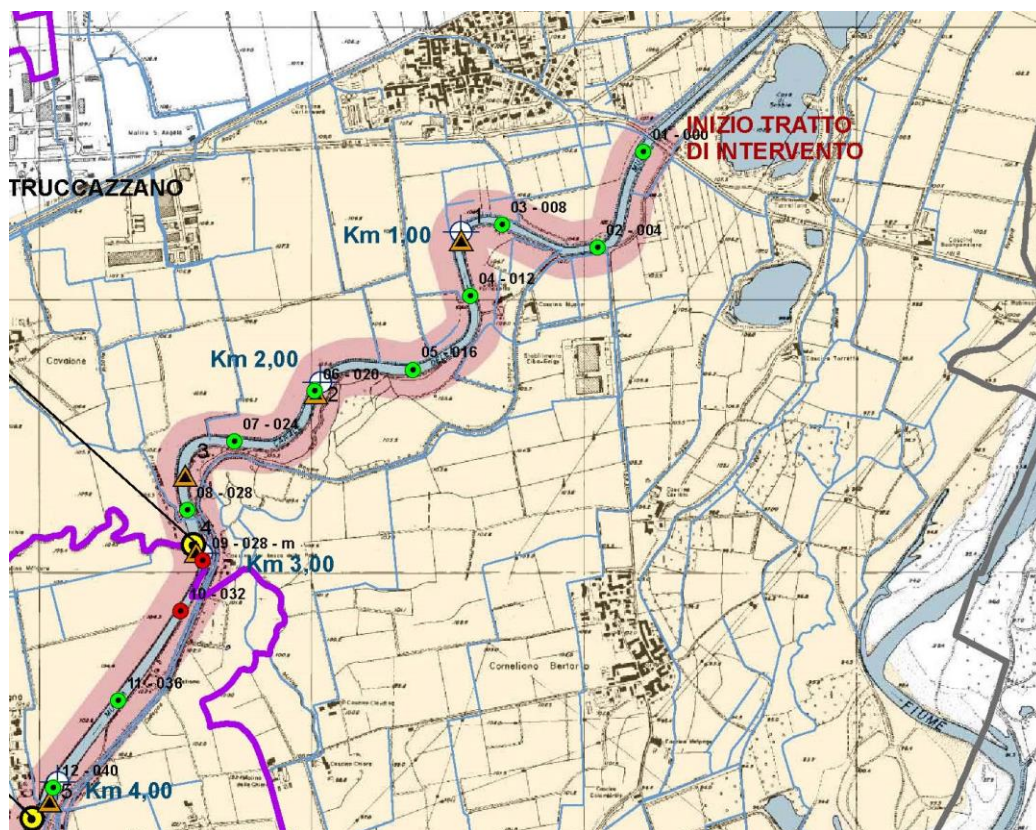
Planimetria generale del progetto – area dell'intervento nell'alveo del Canale Muzza
